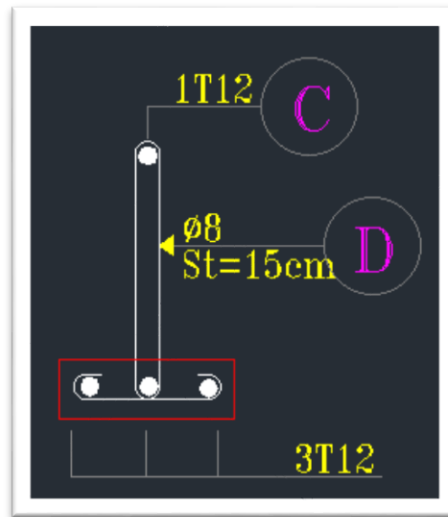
Schéma de ferrailage de la poutrelle sur appui et en travée
